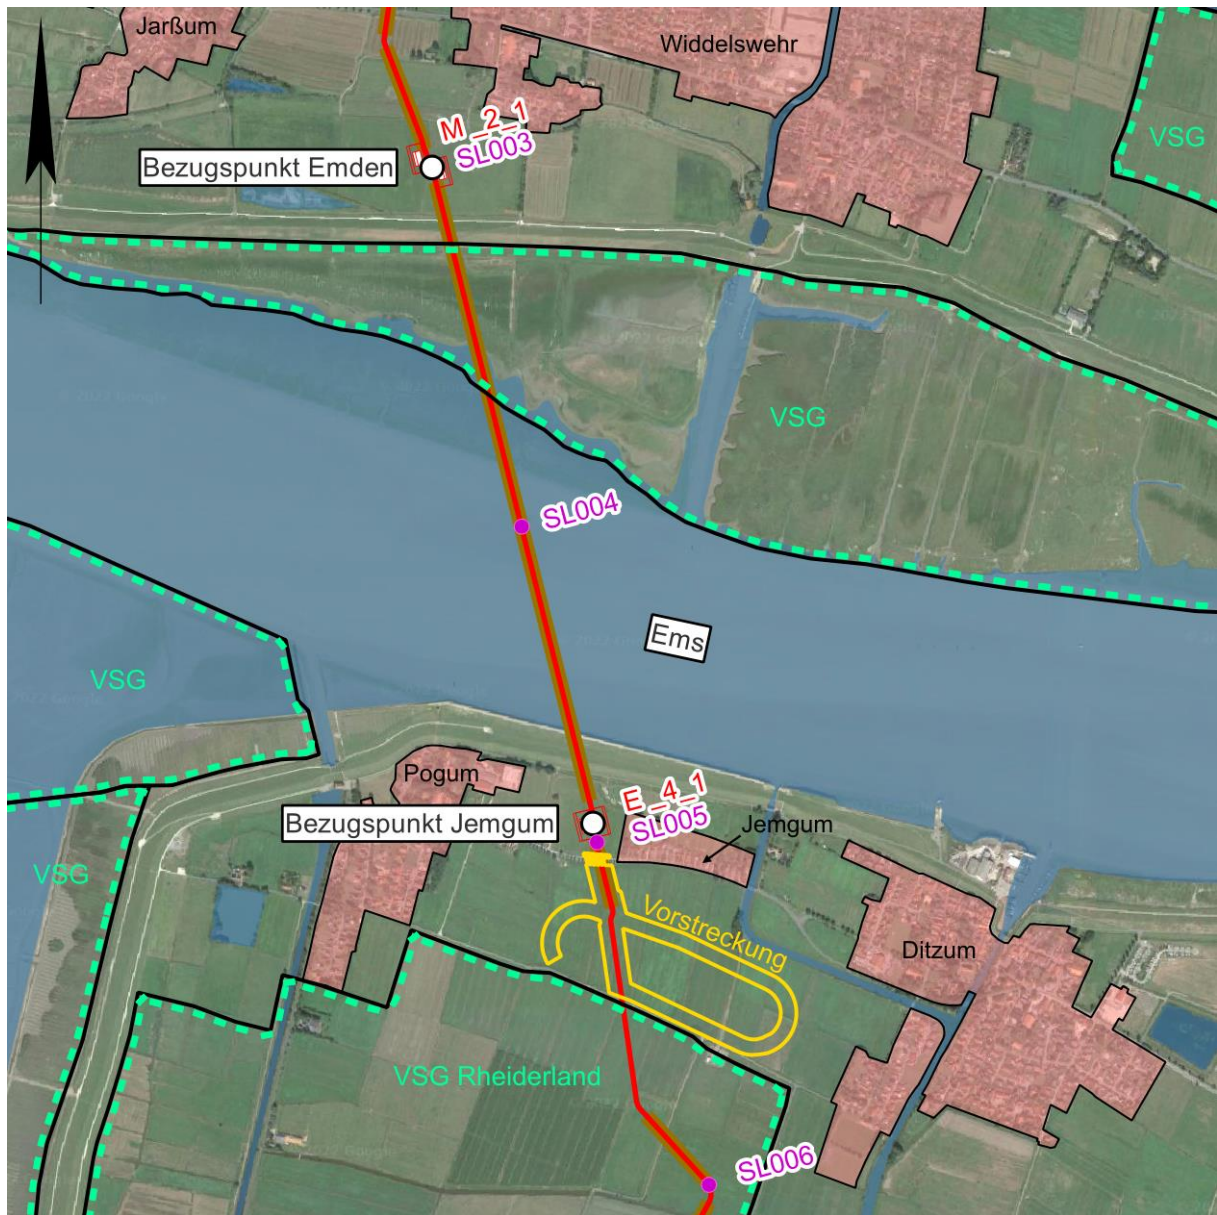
Lageübersicht Emsquering mit Bezugspunkten Emden und Jemgum
